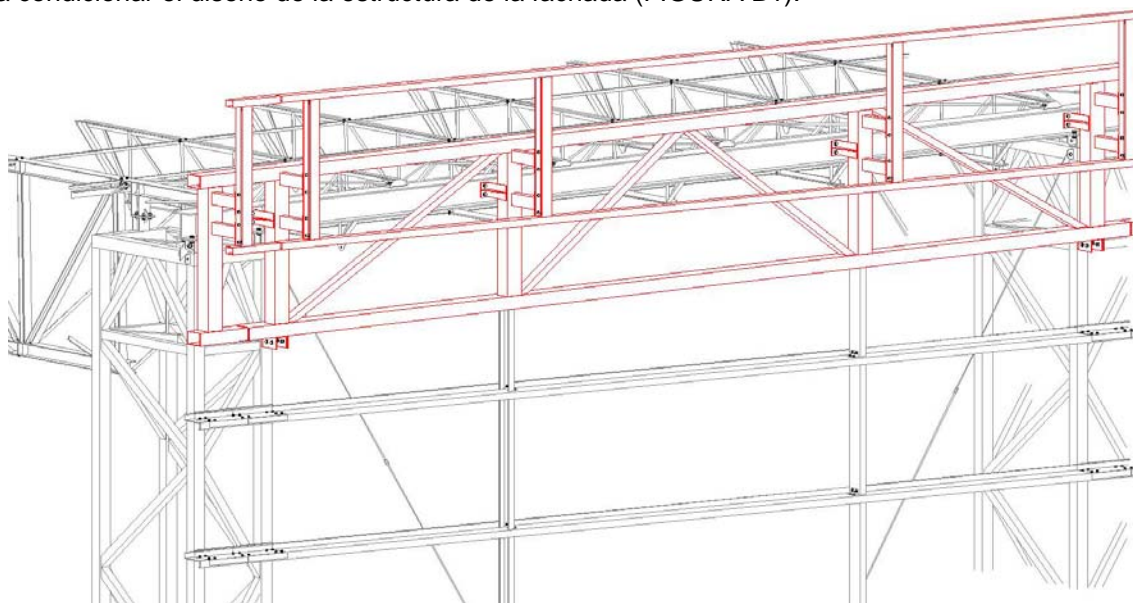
SISTEMA ESTRUCTURAL DE FACHADA
